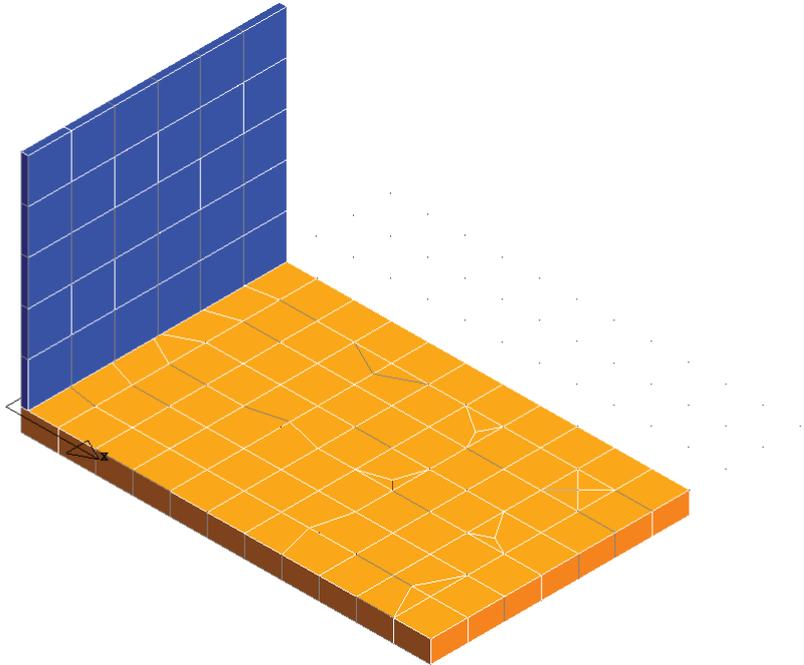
Rappresentazione tridimensionale della struttura (vista anteriore)
